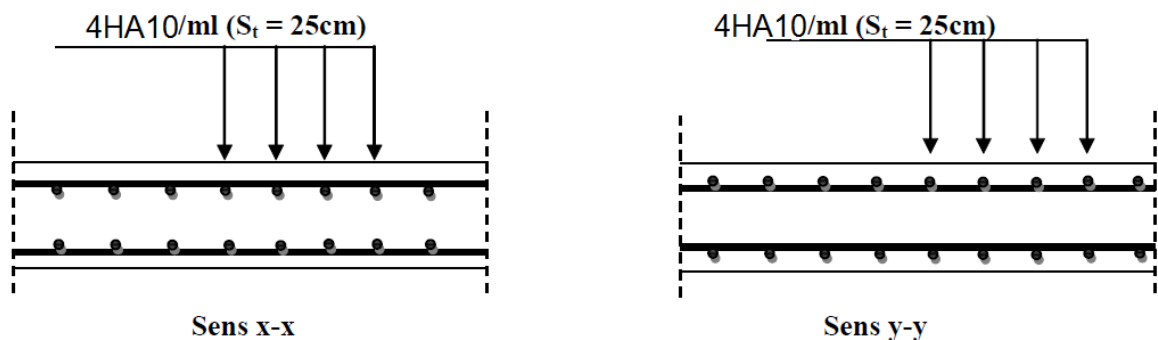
Ferrailage de la dalle pleine de la salle machine
